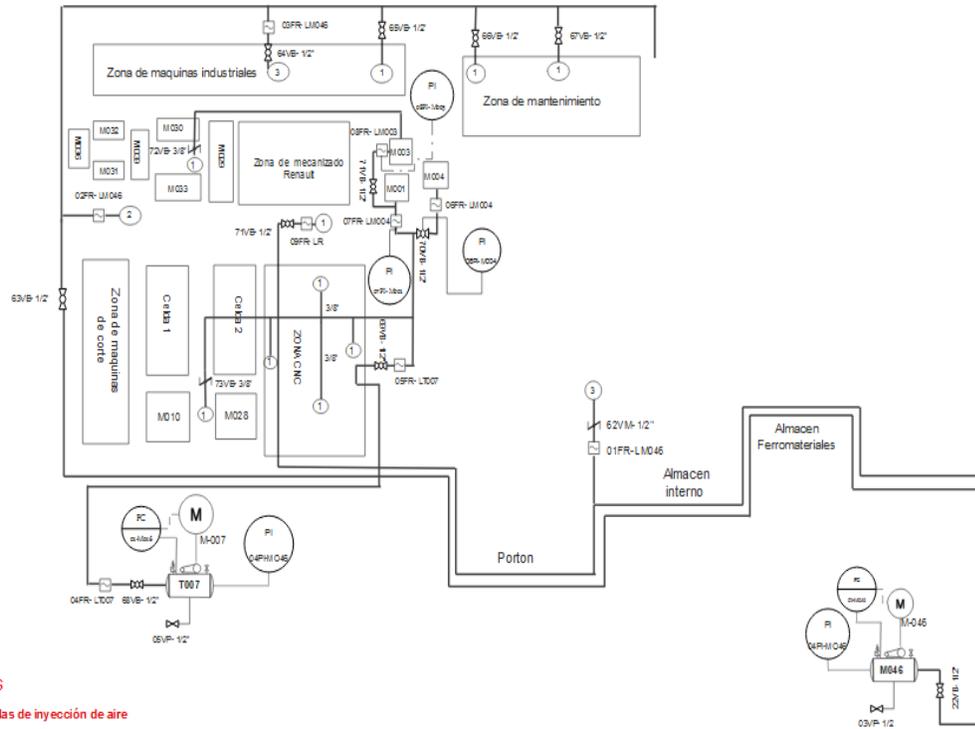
Plano de la línea de alimentación neumática planta de fundición
